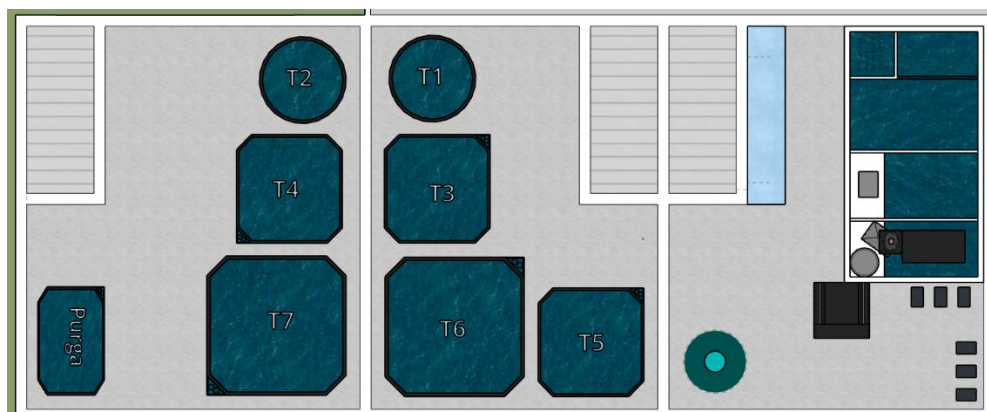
Planta ilustrativa (piso térreo) dos três armazéns adjacentes das instalações. A planta não está à escala (Fonte: SketchUp)
